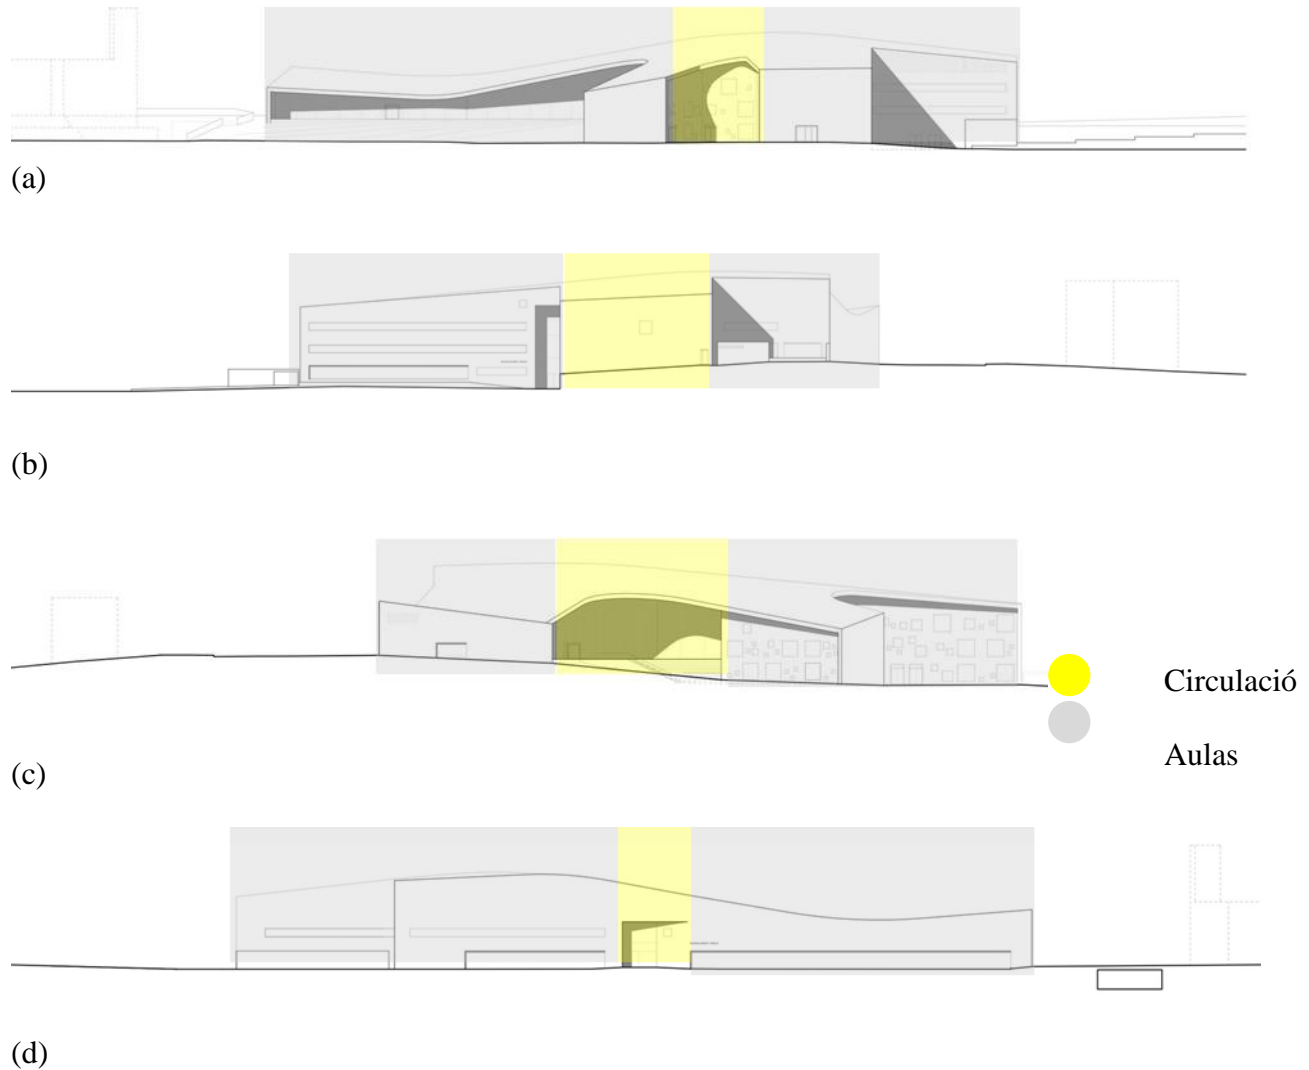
Plantas arquitectónicas del proyecto ESF - parte 2
